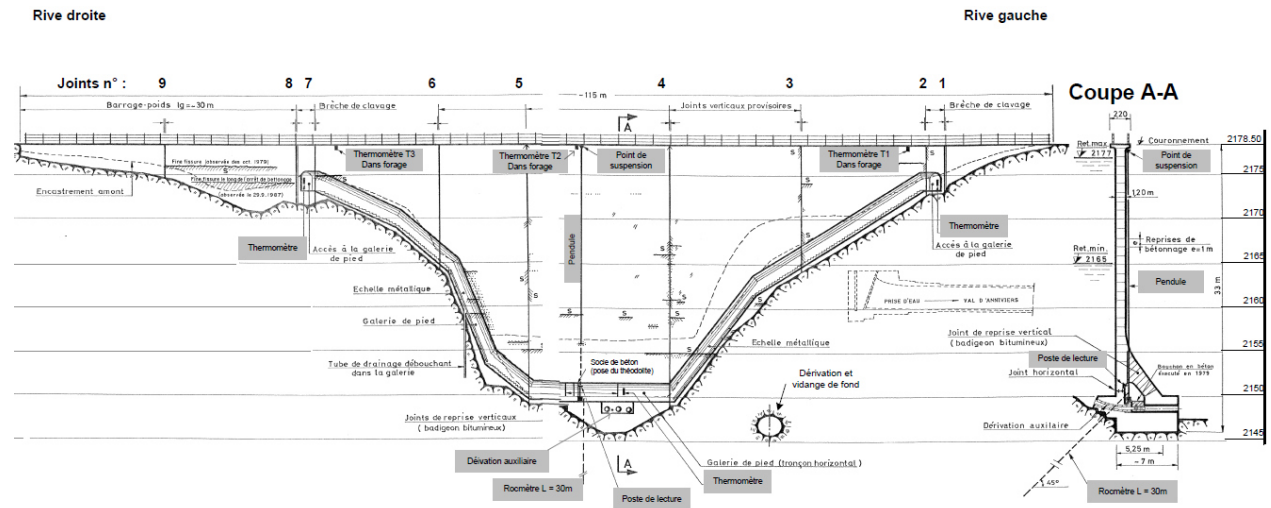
Elévation aval du barrage – coupe verticale à la clé.
